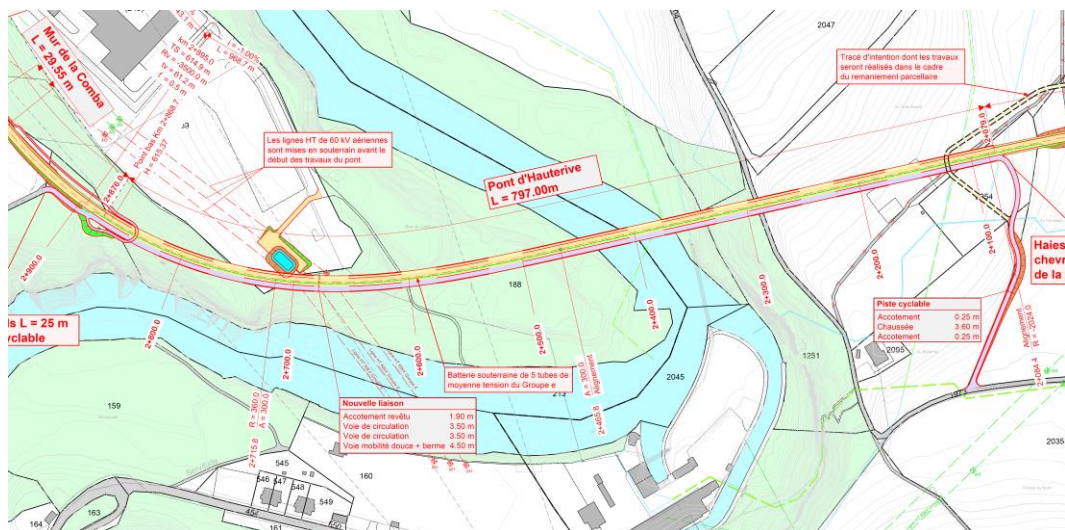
Situation pont d'Hauterive – extrait plan EMMA+ (04.12.2020)
